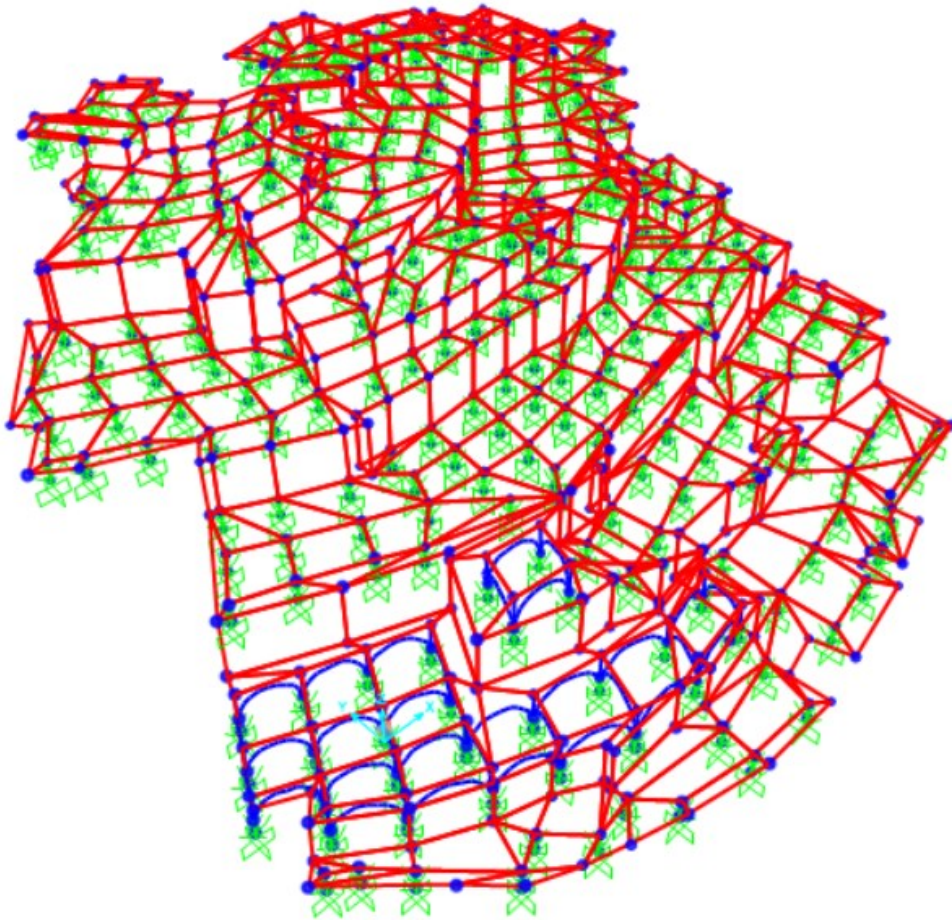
Modellazione della piastra al SAP, Vista Sud-Ovest
